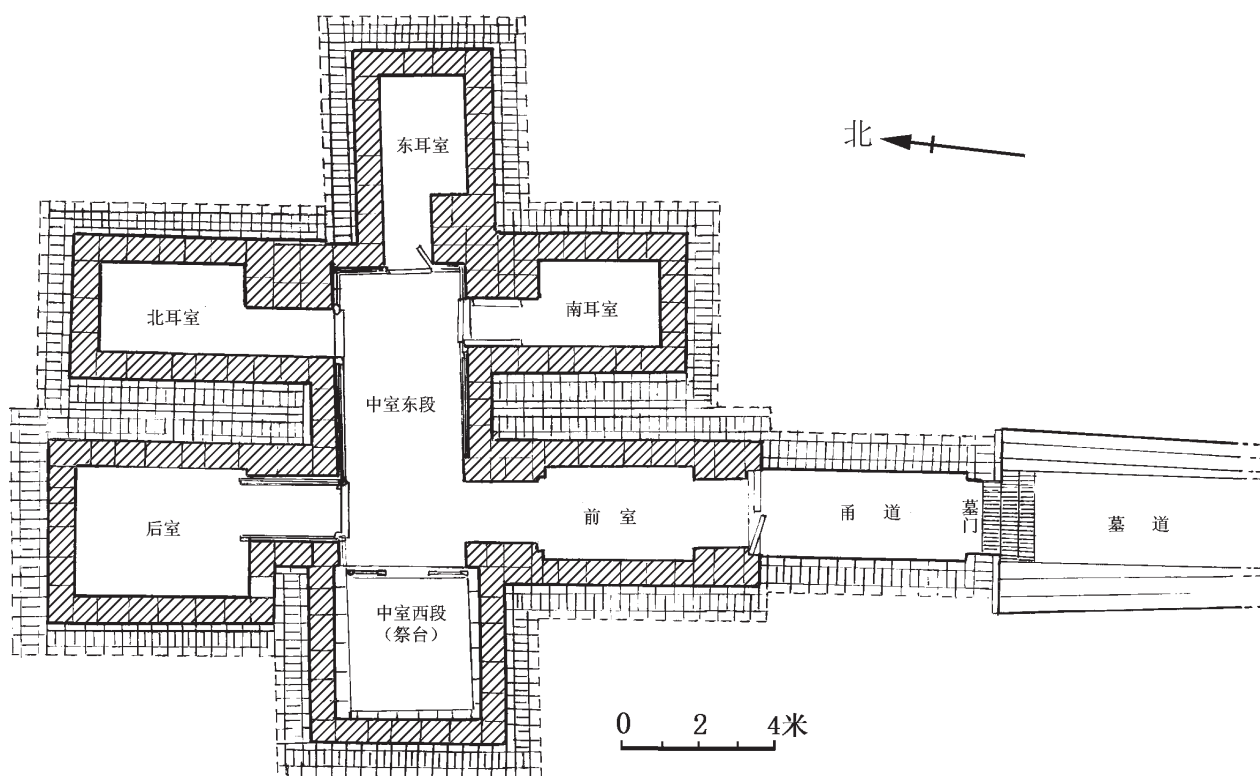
河南省密县打虎亭 1 号汉墓平面图 (1/200)
